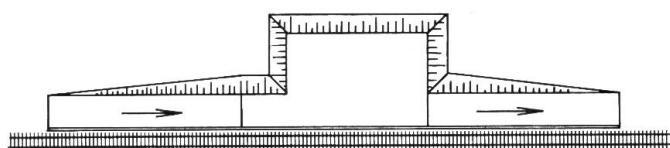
Quai de chargement surélevé à deux rampes avec mur de soutènement et remblai constitué de gravier tout-venant (projection horizontale).
